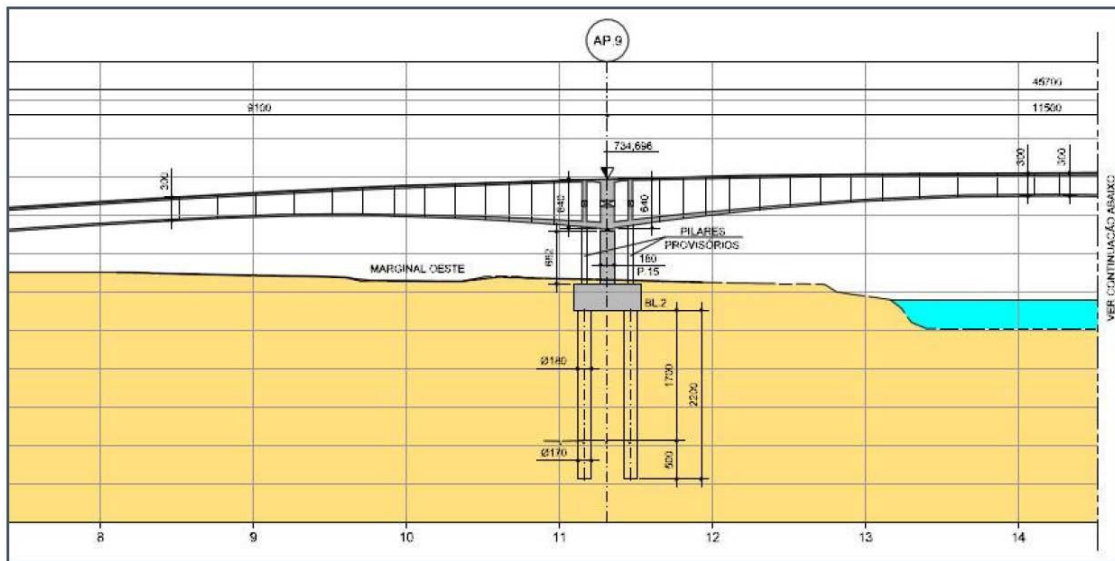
Perfil longitudinal da OAE – pista direita 2/4.
